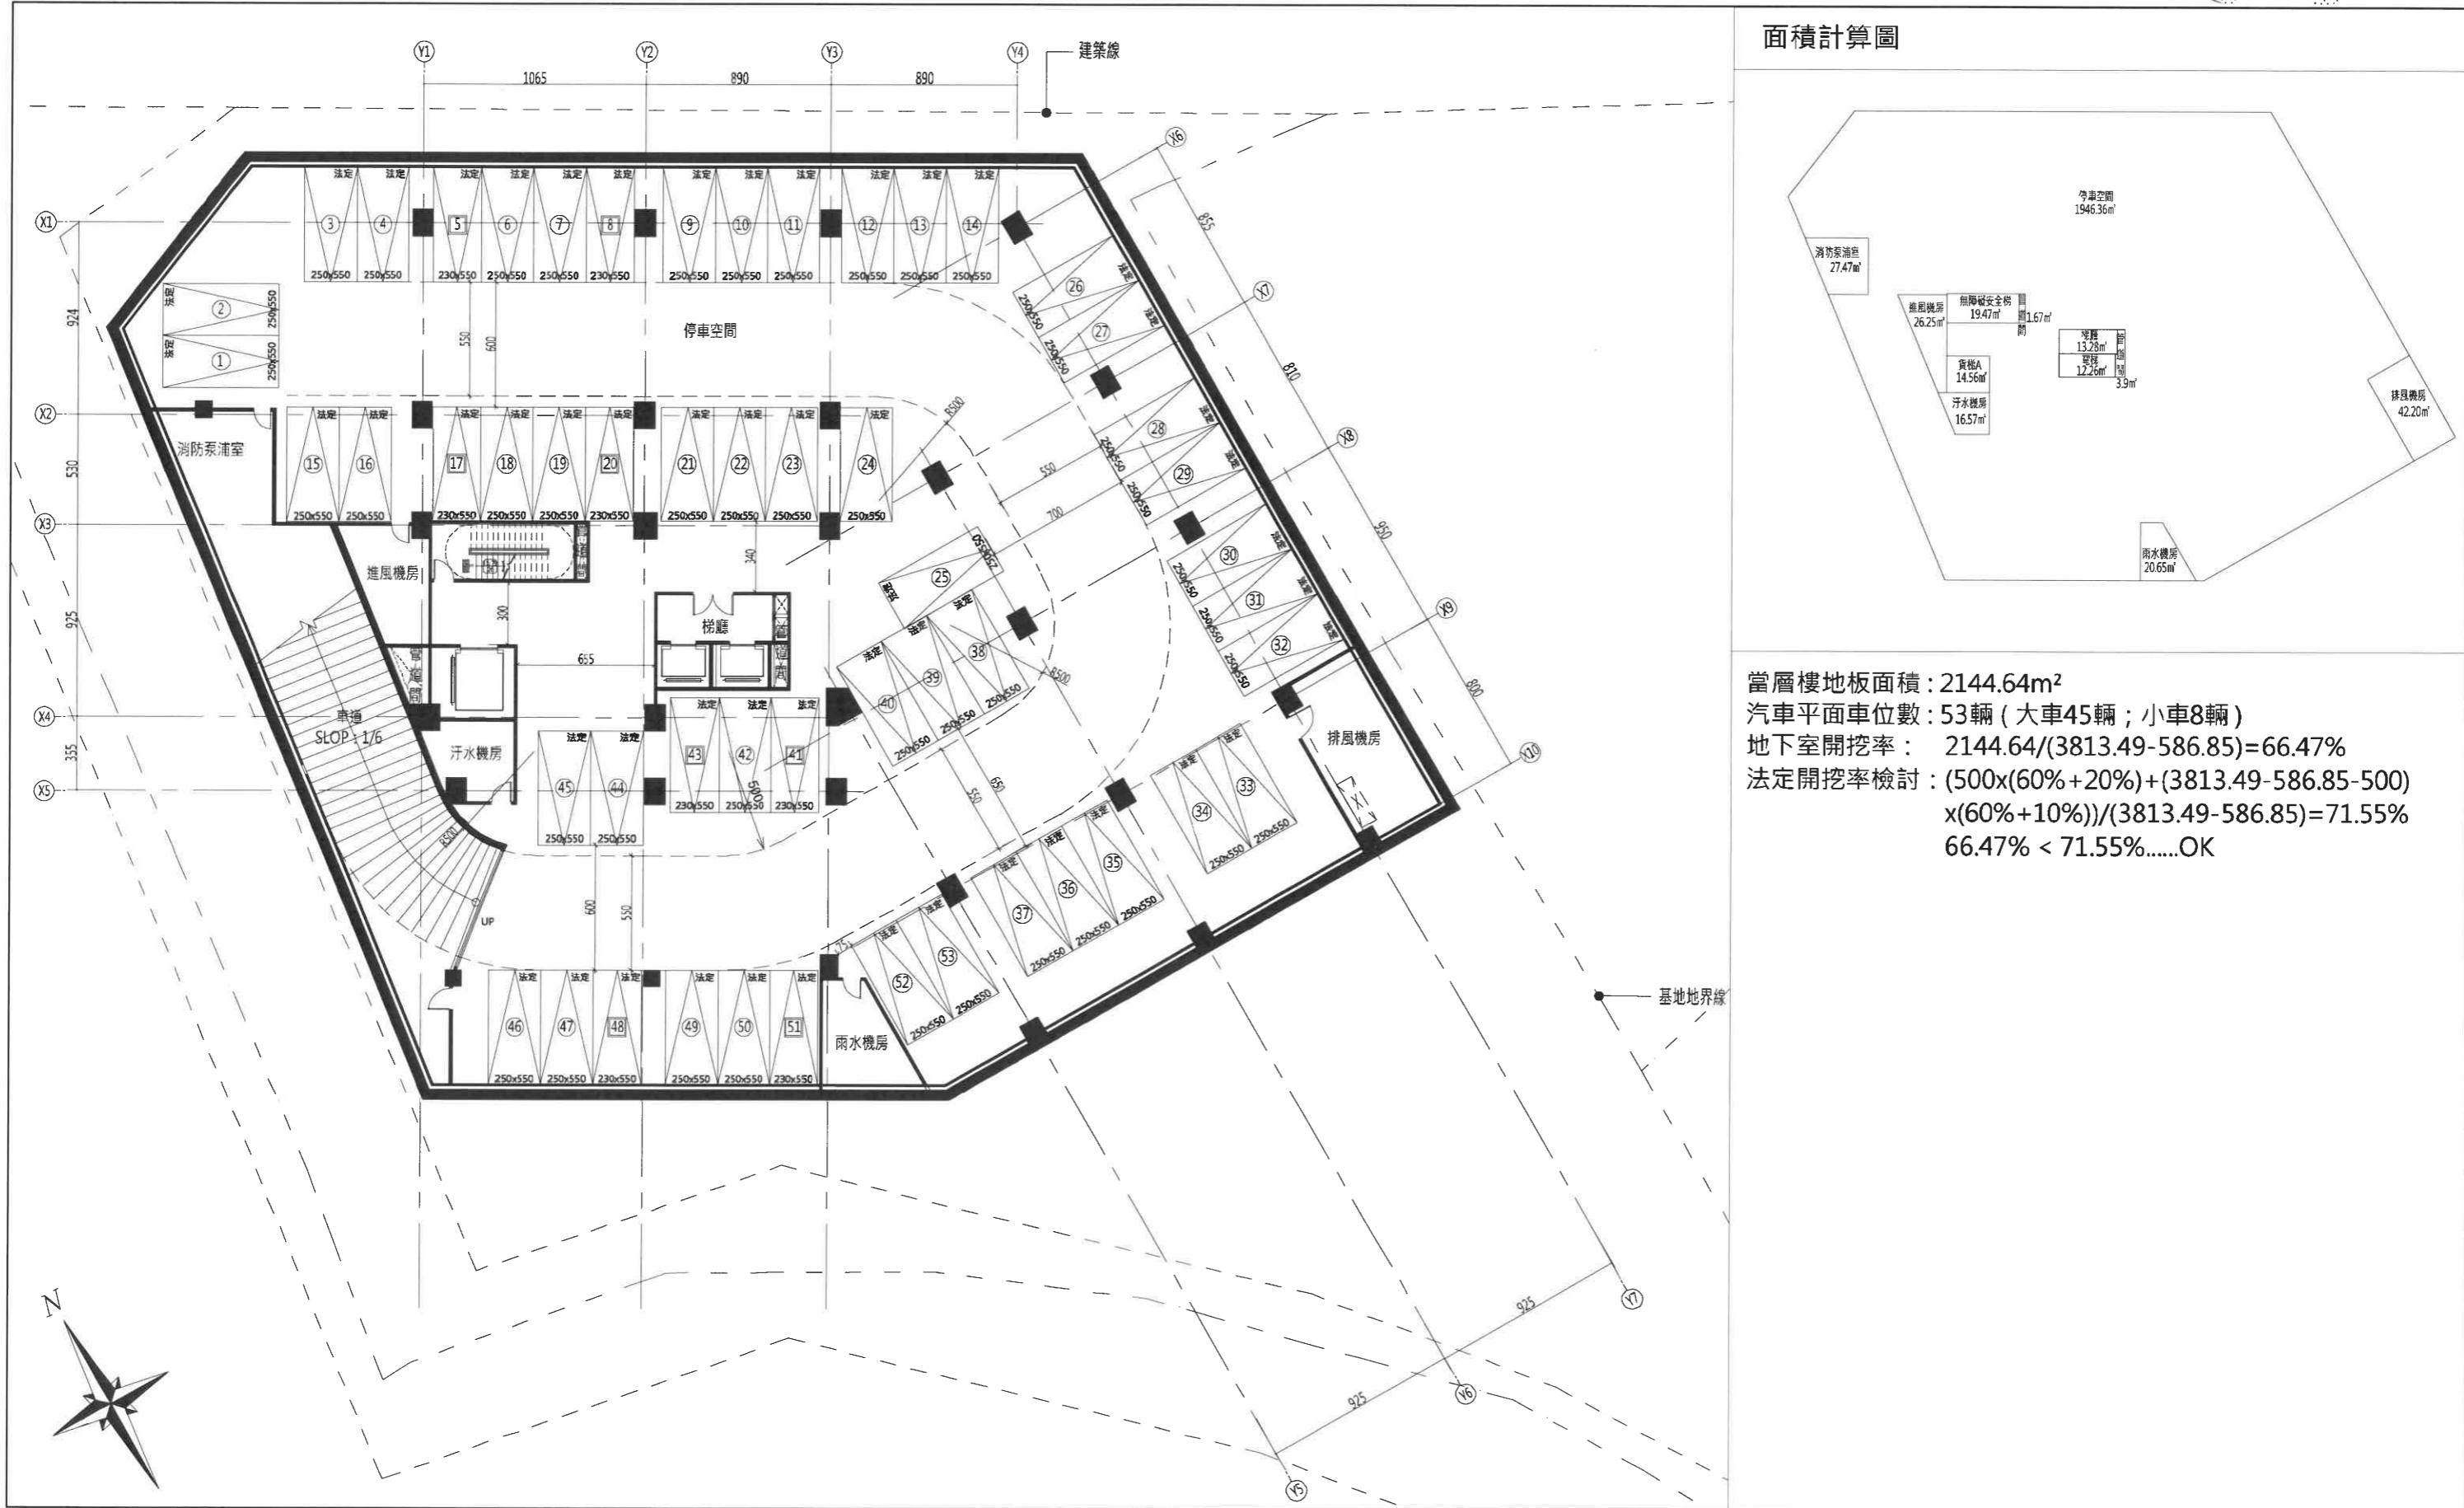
地下二層平面圖(原核定)(S : 1/300)
